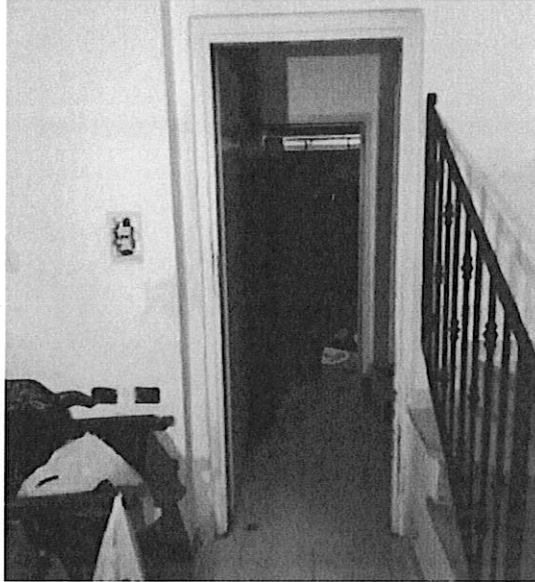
Vista accesso disimpegno tra il locale cantina e l'autorimessa piano interrato
